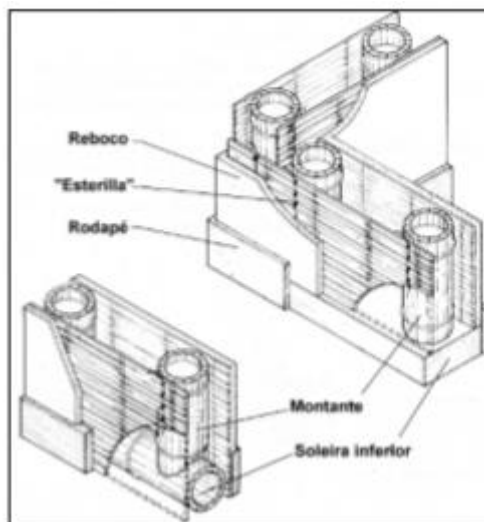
Paredes de esteiras trançadas na vertical e na horizontal
